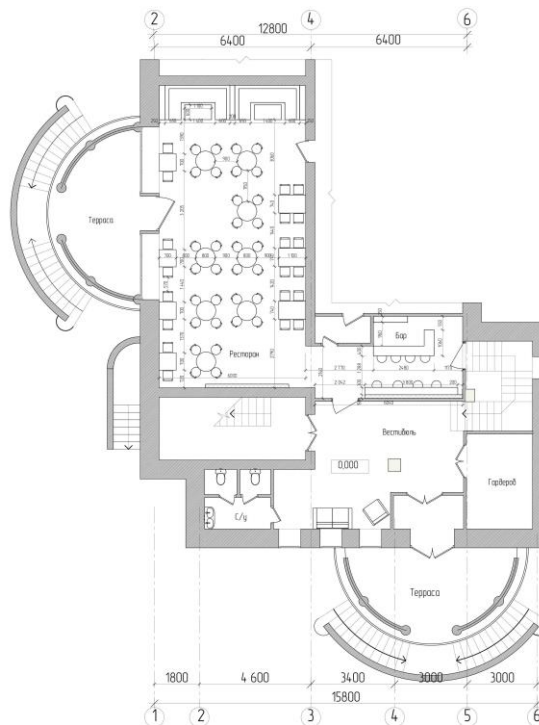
План с расстановкой мебели фрагмента 1 – го этажа
